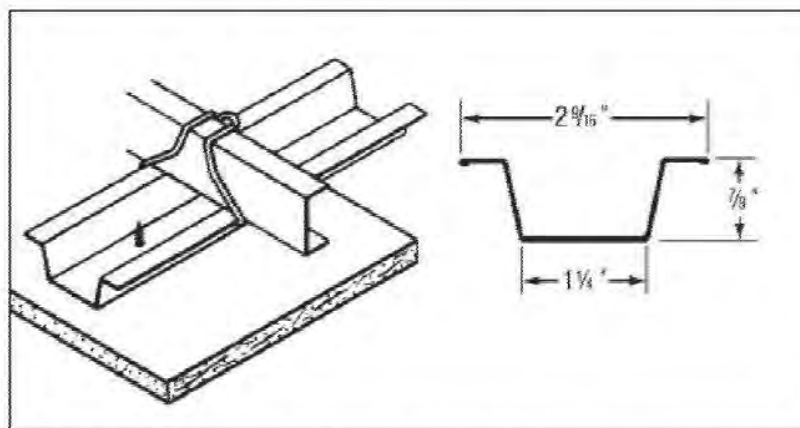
Esquema de aplicación de canal listón para plafones
